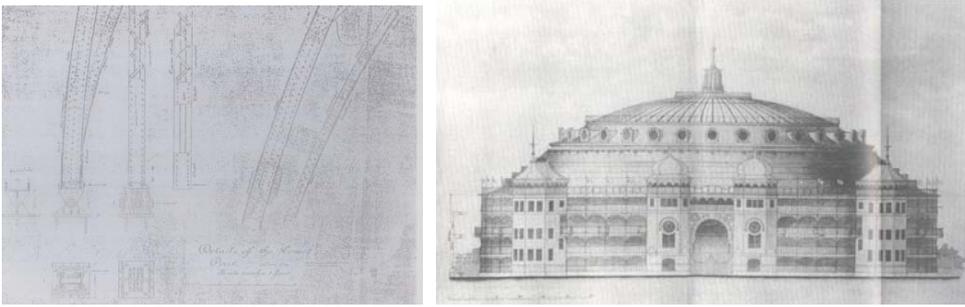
, 800 Détail de la fondation et façade du Gymnase de Sumô de Ryōgoku (1909)
